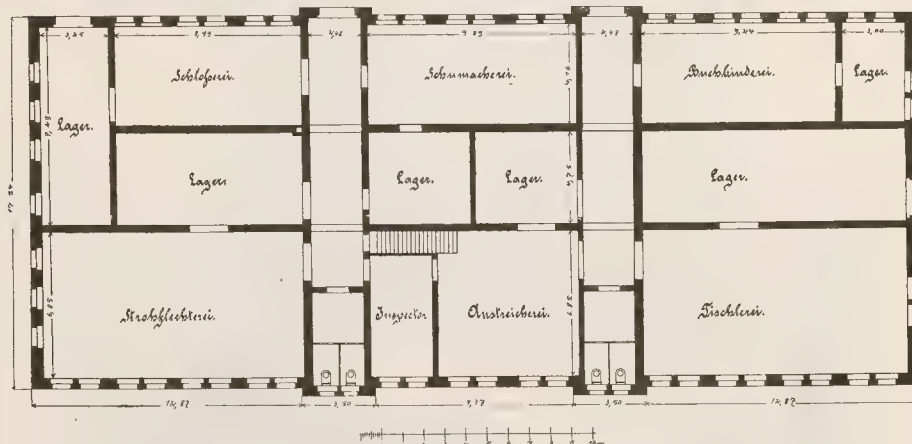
Werkstättengebäude; Grundriss.
